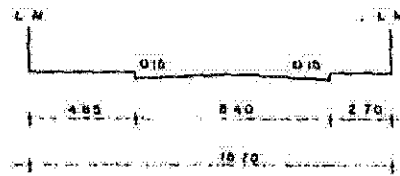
SECCION TRANSVERSAL (16)
